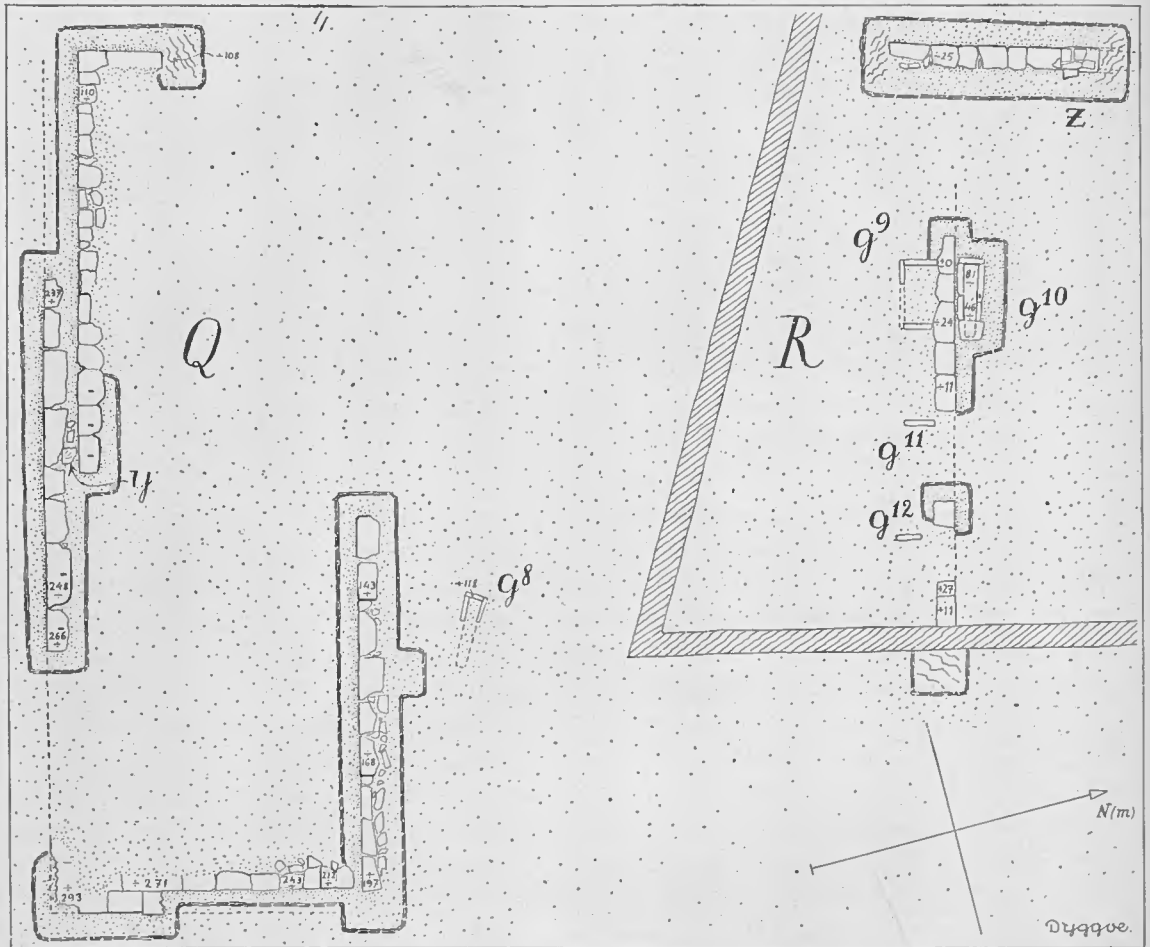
Bau Q—R. Plan 1:200. — E. D.
